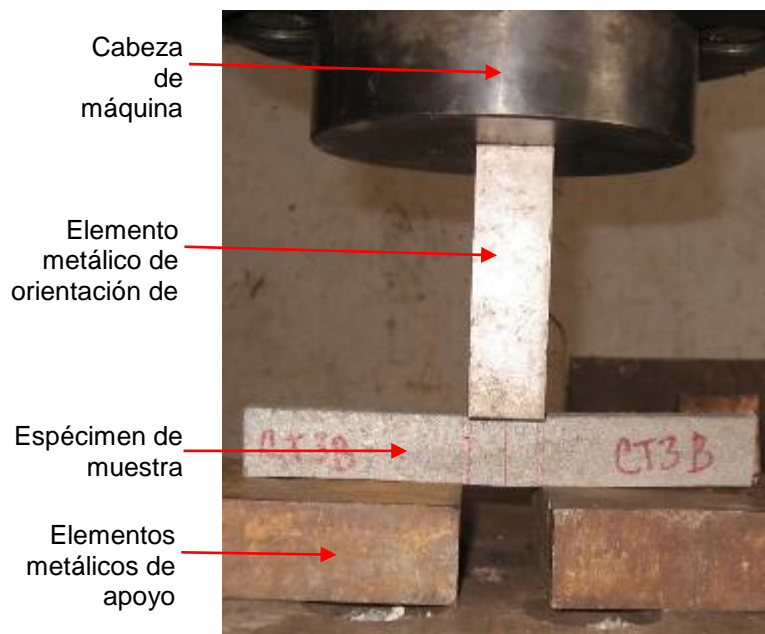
Montaje ensayo a cortante en sección alargada de bloque. Fuente: Autor
